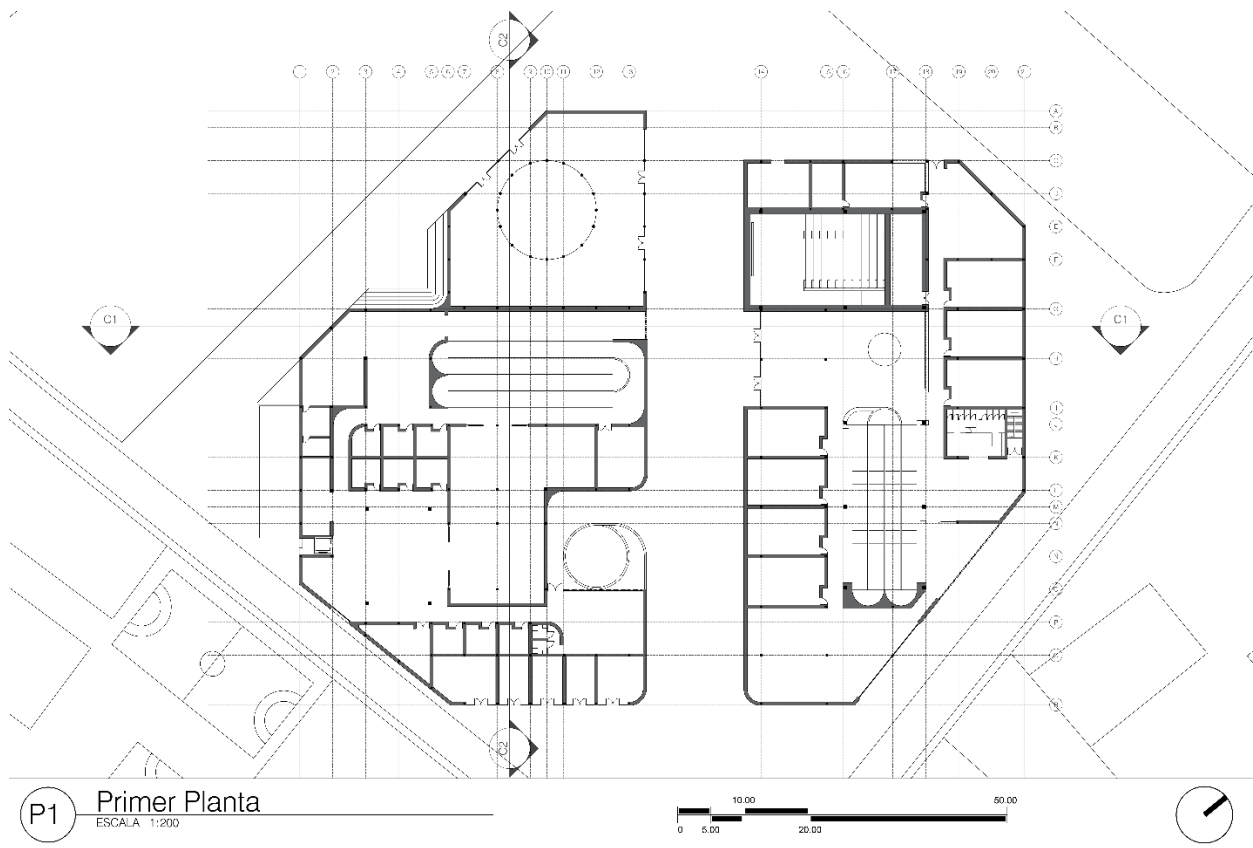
Primer Planta: Sistema Estructural / elaboración propia
